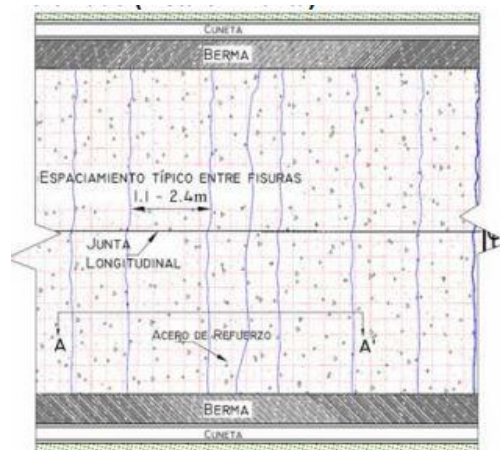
Pavimento de concreto continuamente reforzado. Fuente: INVIAS, 2006.
